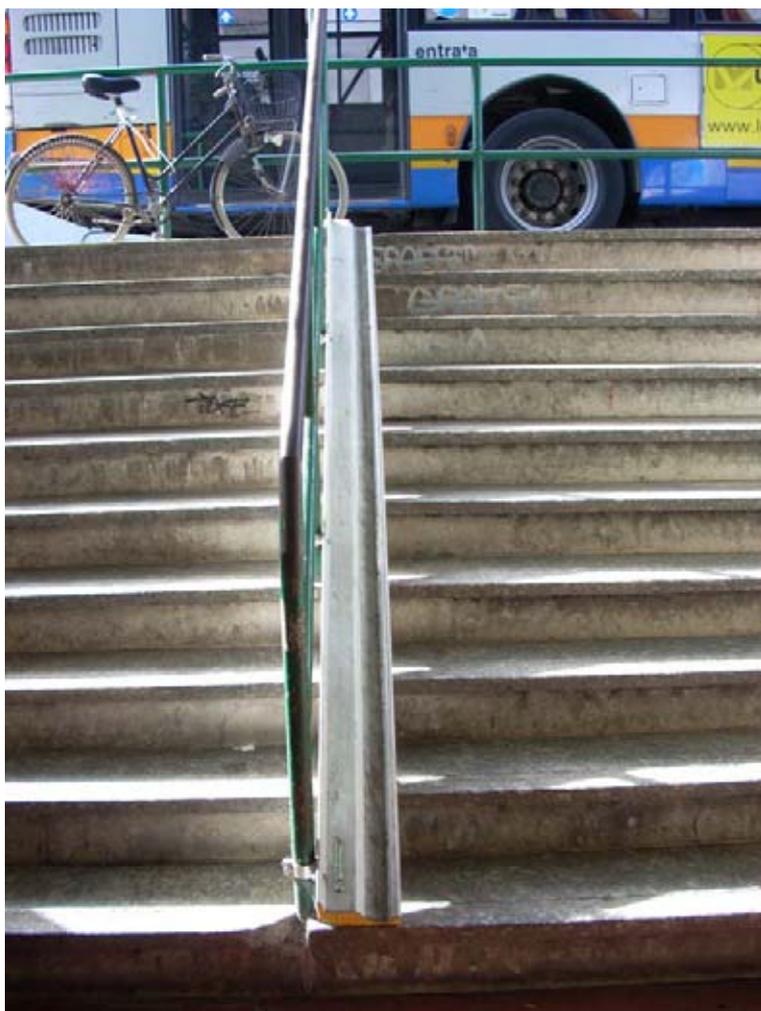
Pavia: nuove canaline ultima versione installazione 2009.
